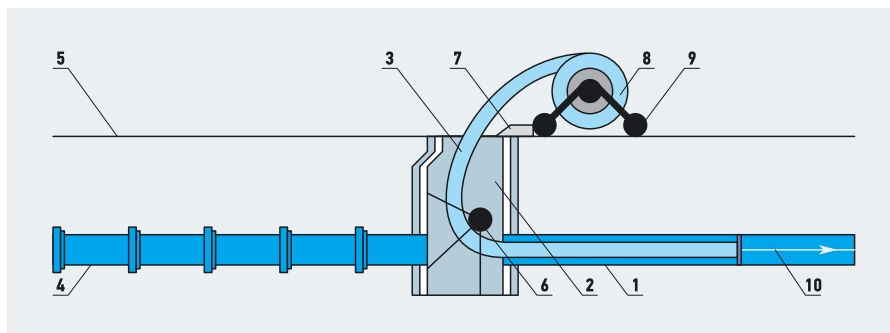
Технологическая схема реконструкции ветхого трубопровода сматыванием с барабана полиэтиленовой трубы с измененным поперечным сечением (1, 4 — ветхий трубопровод; 2 — смотровой колодец; 3 — трубная плеть; 5 — поверхность земли; 6 — роликовая опора; 7 — стопор; 8 — барабан; 9 — тележка; 10 — тяговый трос)
